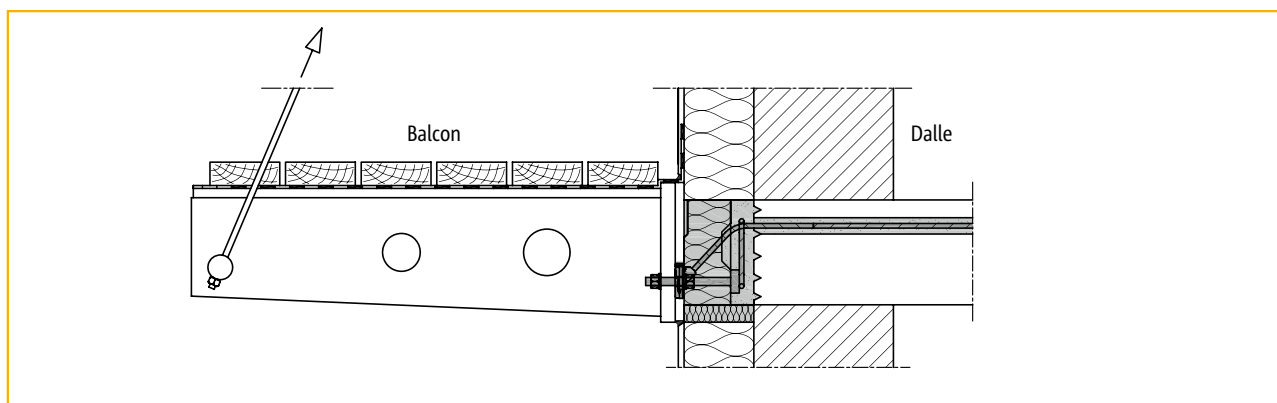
balcon suspendu pour la rénovation d'un balcon existant
